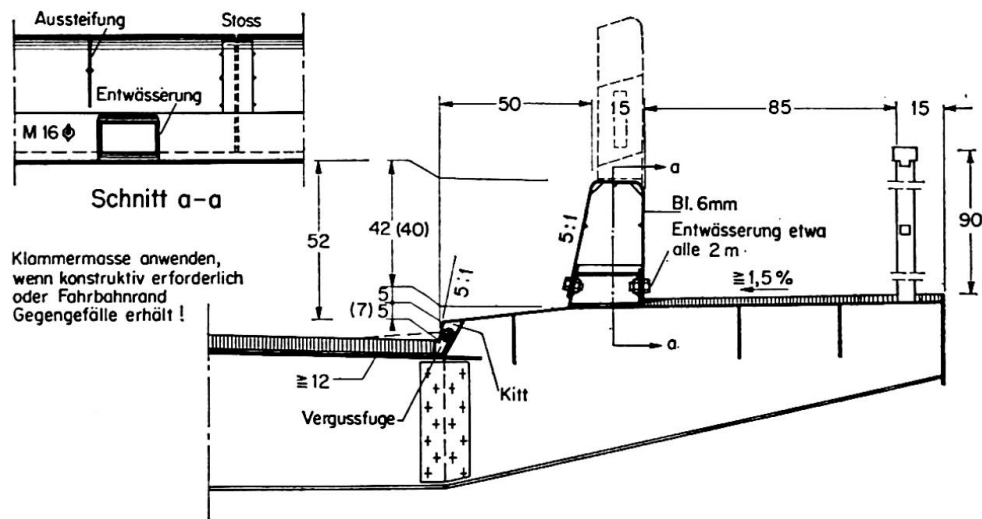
Leitschwelle aus Stahl (aufgesetzter Leitpfosten entsprechend Ausstattung der freien Strecke!).
